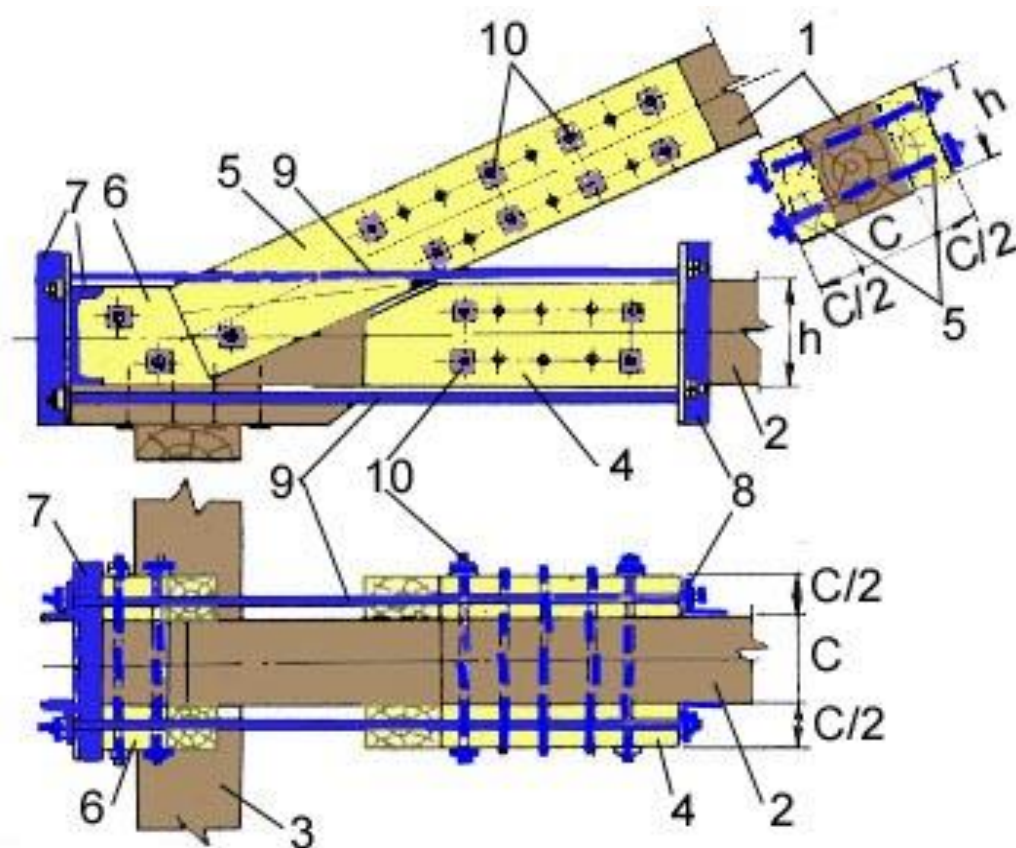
Усиление опорного узла деревянной фермы: 1 – верхний пояс стропильной конструкции; 2 – нижний пояс стропильной конструкции; 3 – мауэрлатный брус; 4 – деревянные накладки из досок на нижнем поясе; 5 – деревянные накладки из досок на верхнем поясе; 6 – деревянные накладки-упоры; 7, 8 – стальные упоры; 9 – стальные тяжи $\Phi 16$ мм; 10 – стяжные болты.
